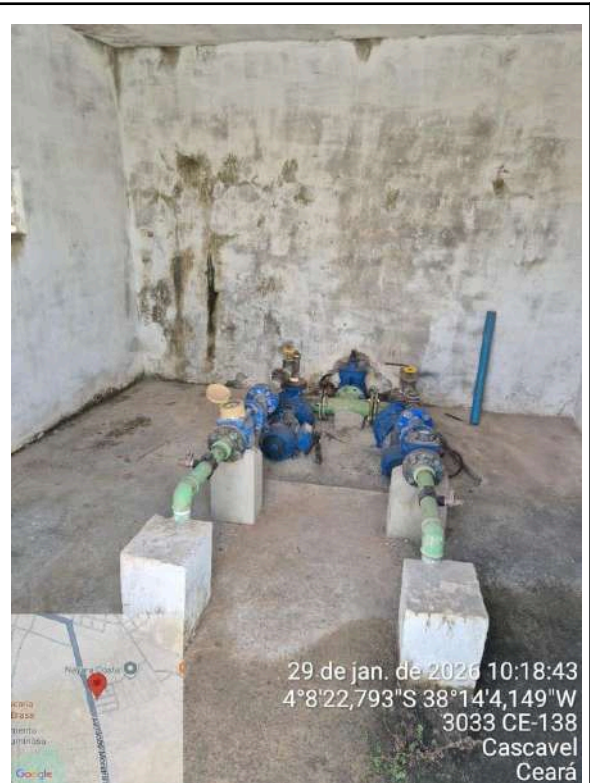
ETA-01 (Sede): parede da casa de bomba quebrada, com aberturas inadequadas e tinta desgastada.
